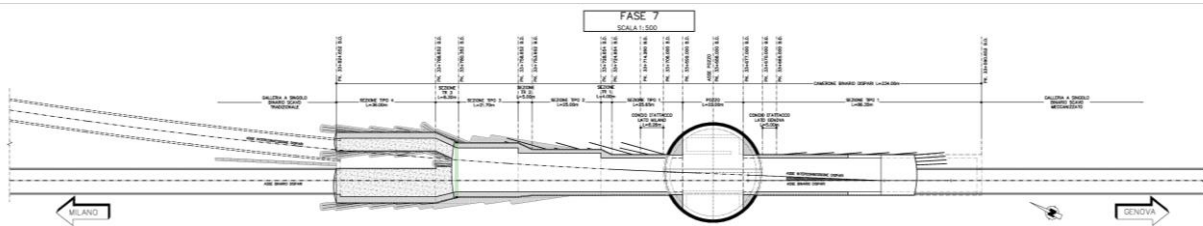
Avanzamento piena sezione lato Genova e scavo allargo di calotta lato Milano
